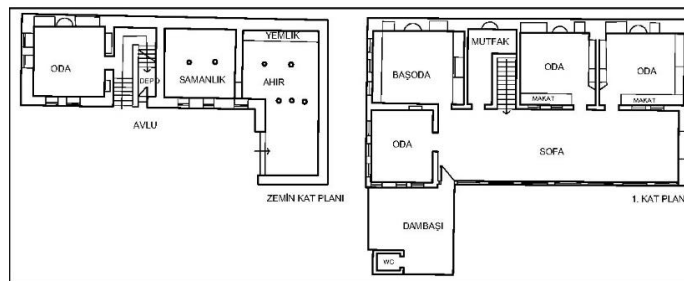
Kerim Nacan Evi kat planları (Sayan, 1995 çizimlerinden güncellenmiştir) (Kerim Nacan House floor plans (updated from Sayan, 1995 drawings))
